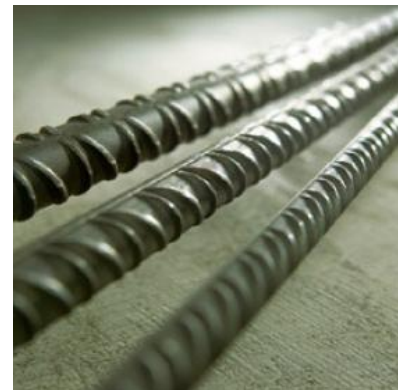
Barras de Ensayo de Acero Fuente: Web Oficial Laboratorio GIA
